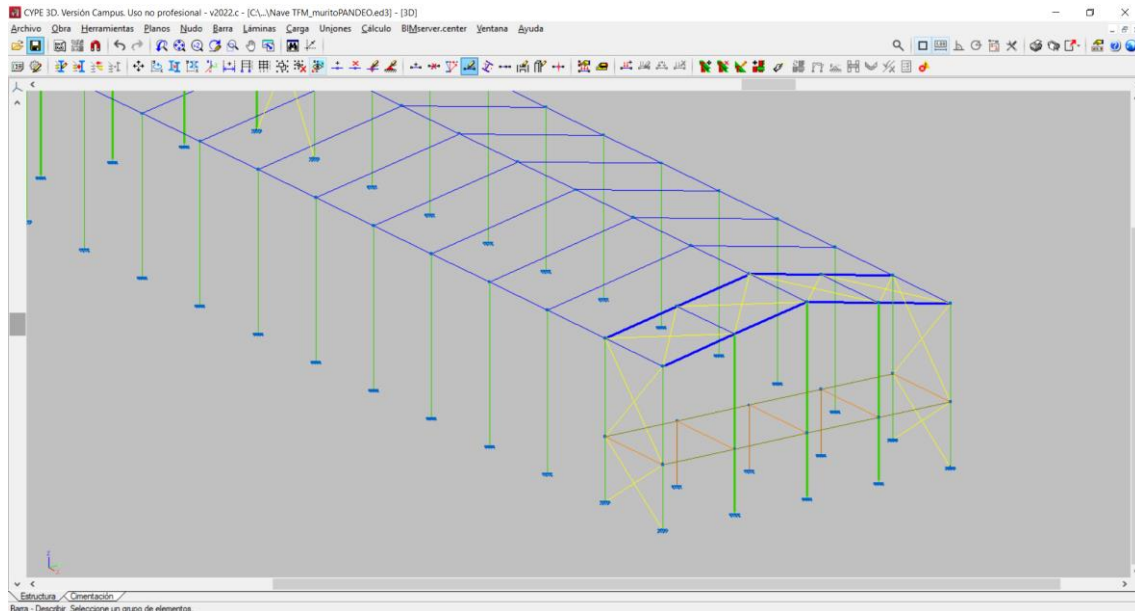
17 Barras de grupo 6 – Vigas longitudinales 1ª planta indicados en naranja
